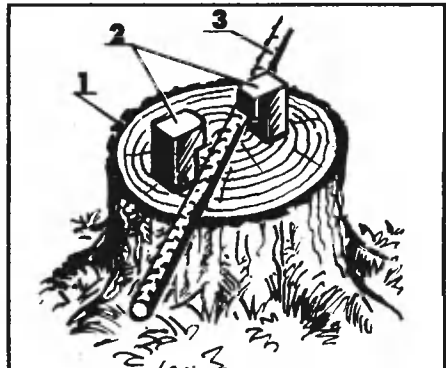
Приспособление для гибки арматуры: 1 – пень; 2 – колышки; 3 – арматурный прут
